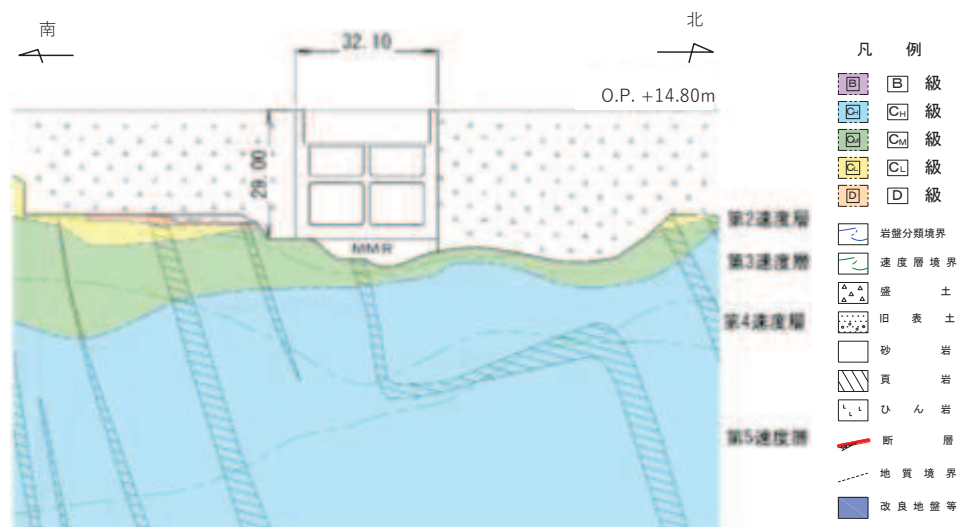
第3号機海水ポンプ室の地質断面図 (㉕-㉕断面)
